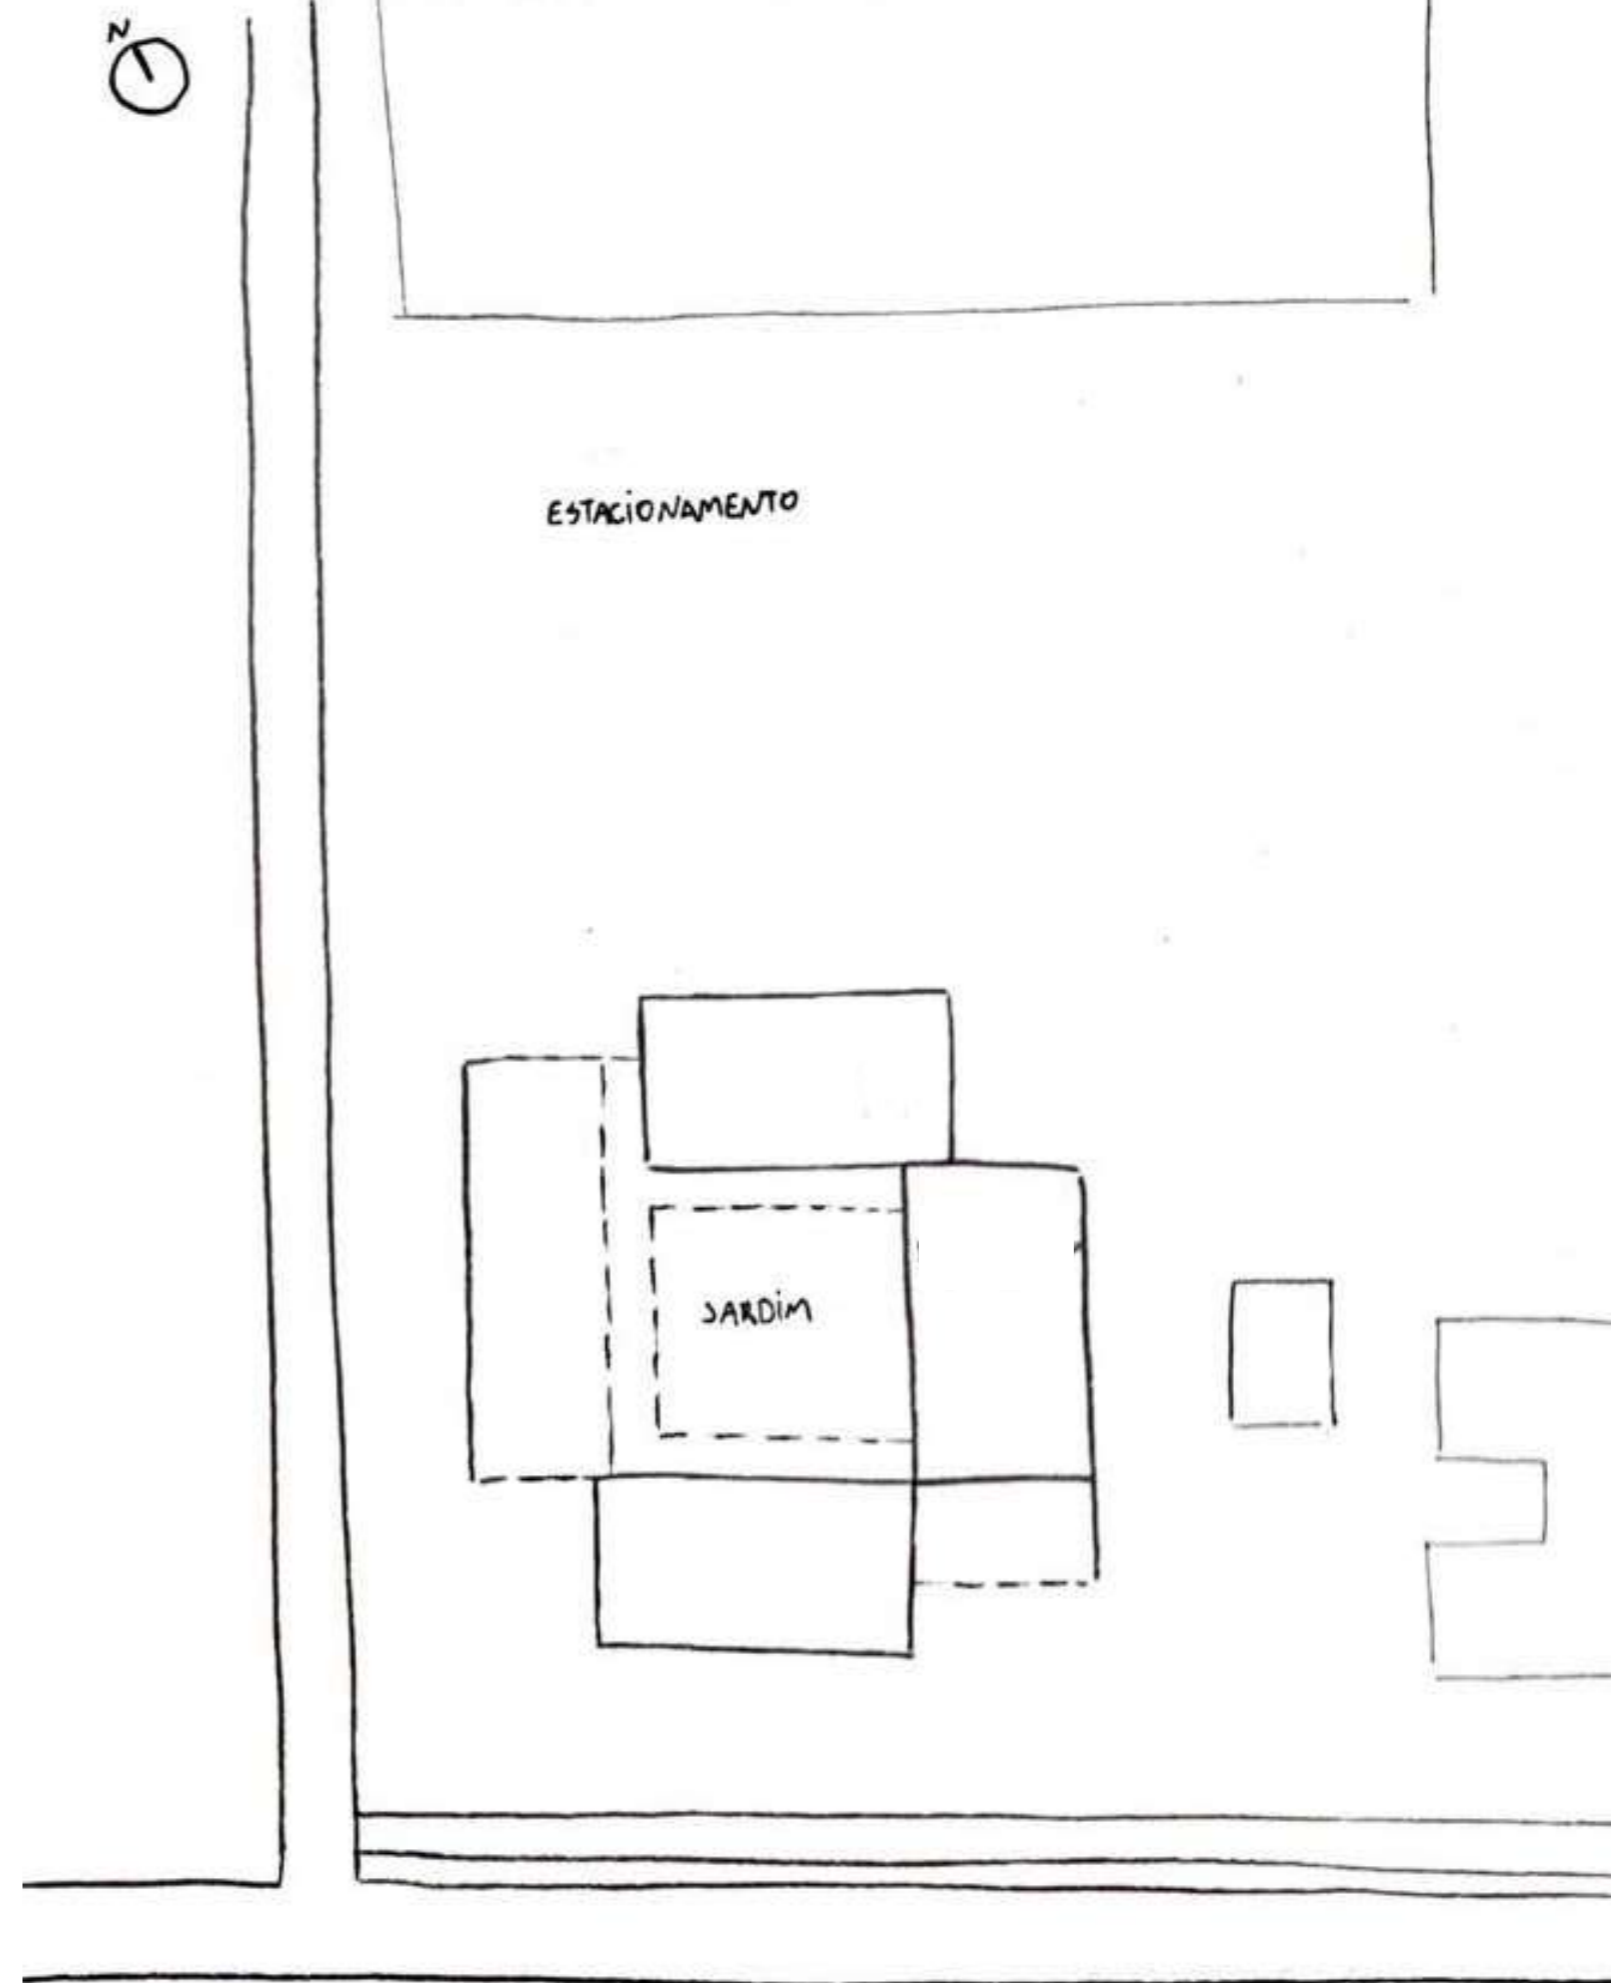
Croqui da planta baixa do partido. Elaborado por Ana Coêlho.
